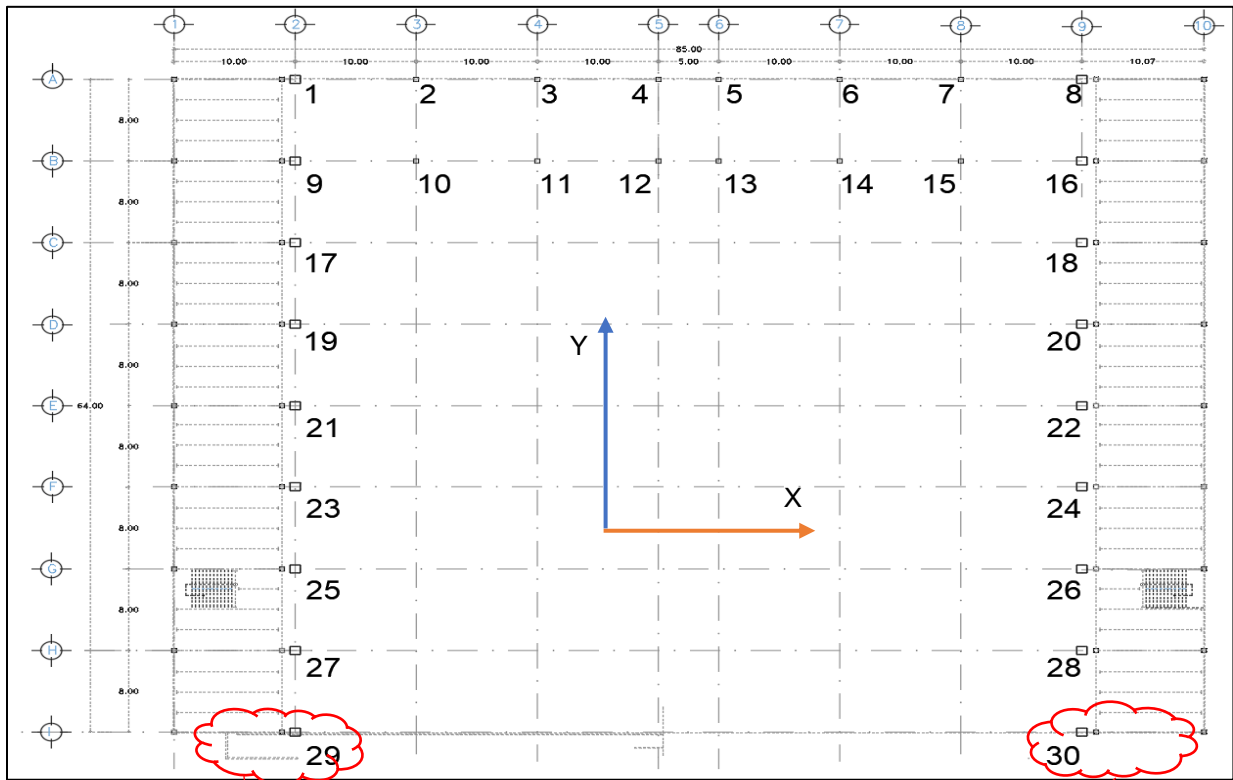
Sembrado de columnas en Hangar y puertas de acceso.
